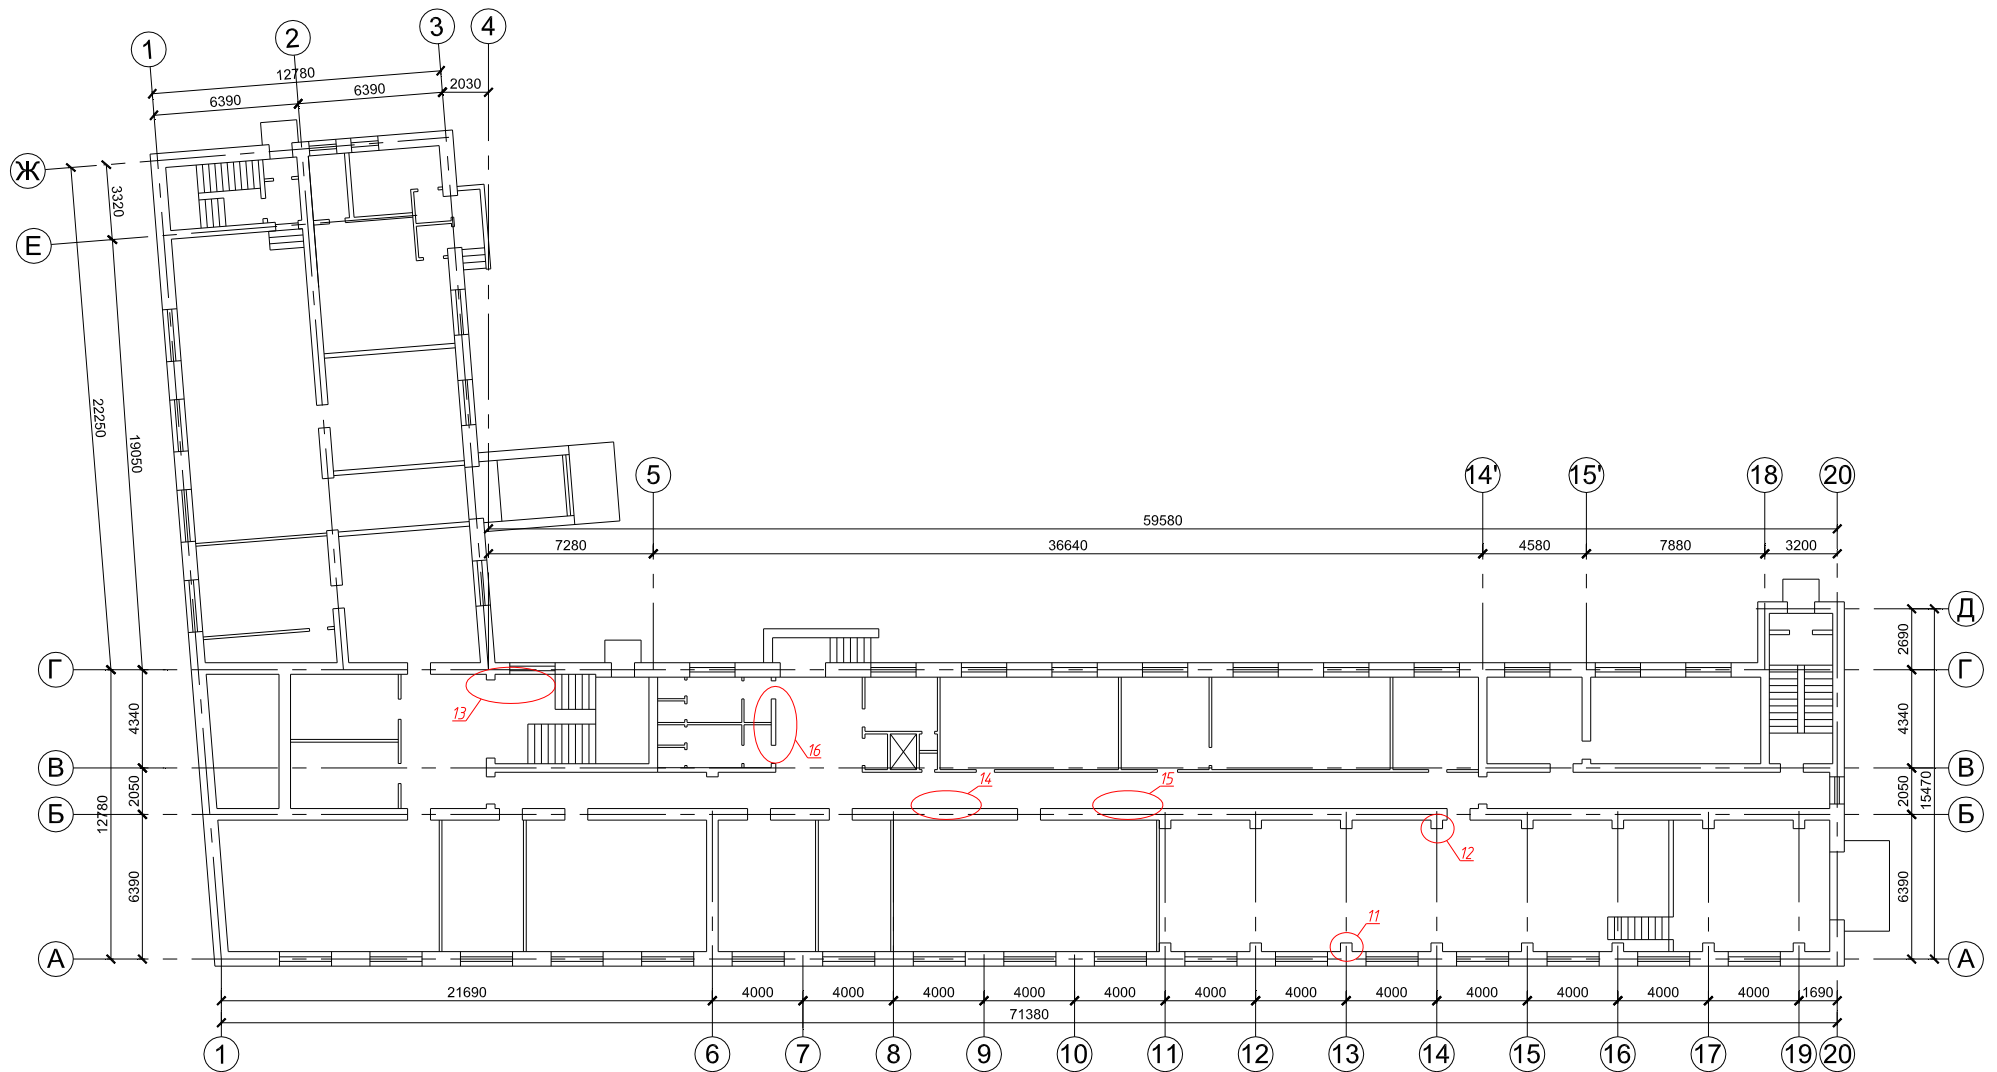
Карта дефектов и повреждений внутренних помещений цокольного этажа здания.
